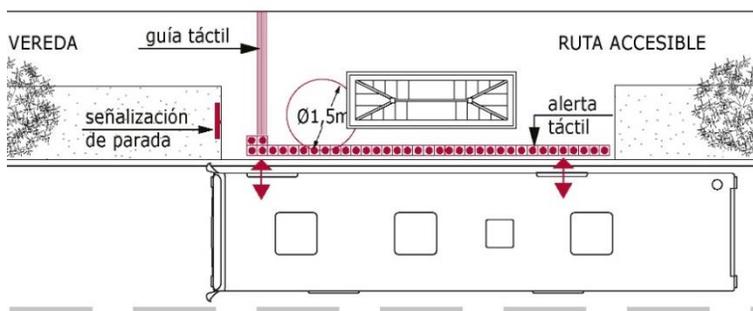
Paradero conectado a nivel con la ruta accesible.
